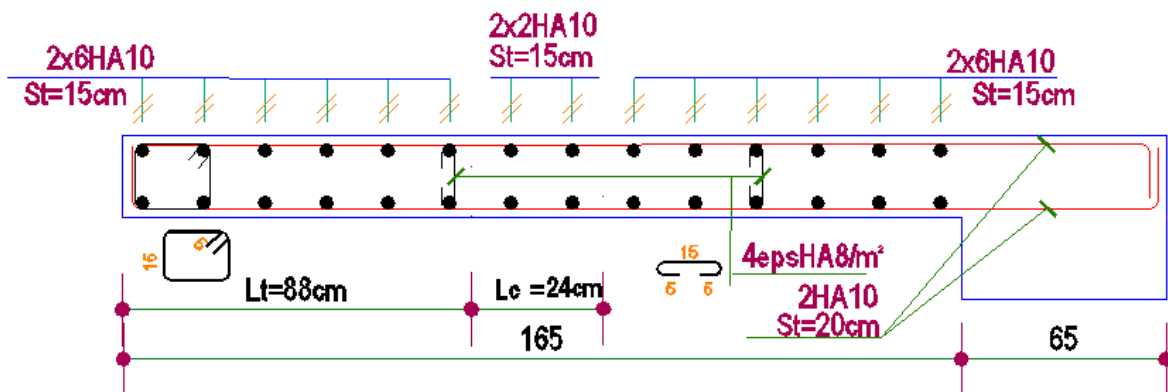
Schéma de ferrailage de Vx1 du niveau RDC
